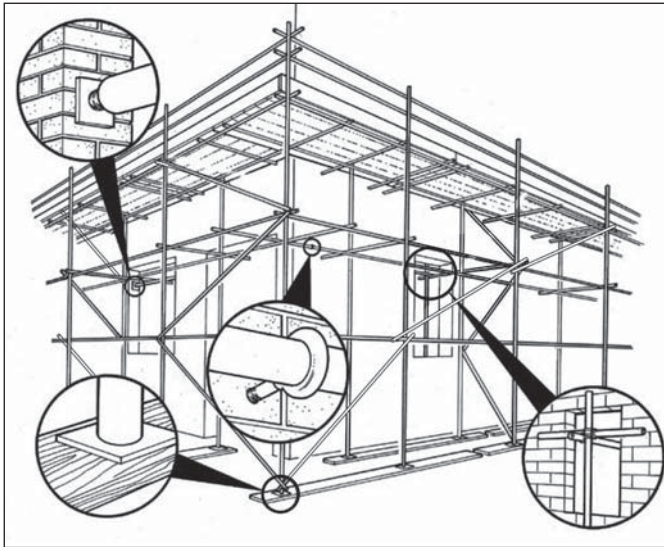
Наружные строительные леса с обустроенным ограждением по краям, связями жесткости, опорными подкладками и гибкими связями
